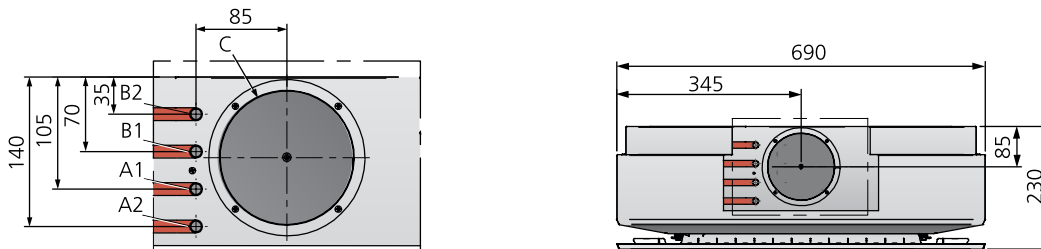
ADAPT Parasol EX 690, вид сбоку
